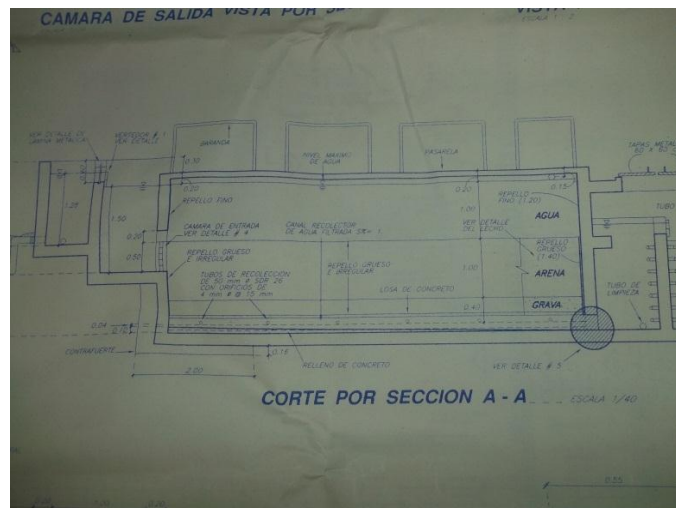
Corte Lateral en plano del filtro lento de arena. Fuente: Autor de plano de AyA.
